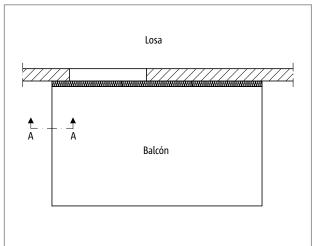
Schöck Isokorb® T tipo K: Ilustración de la posición de sección A-A
